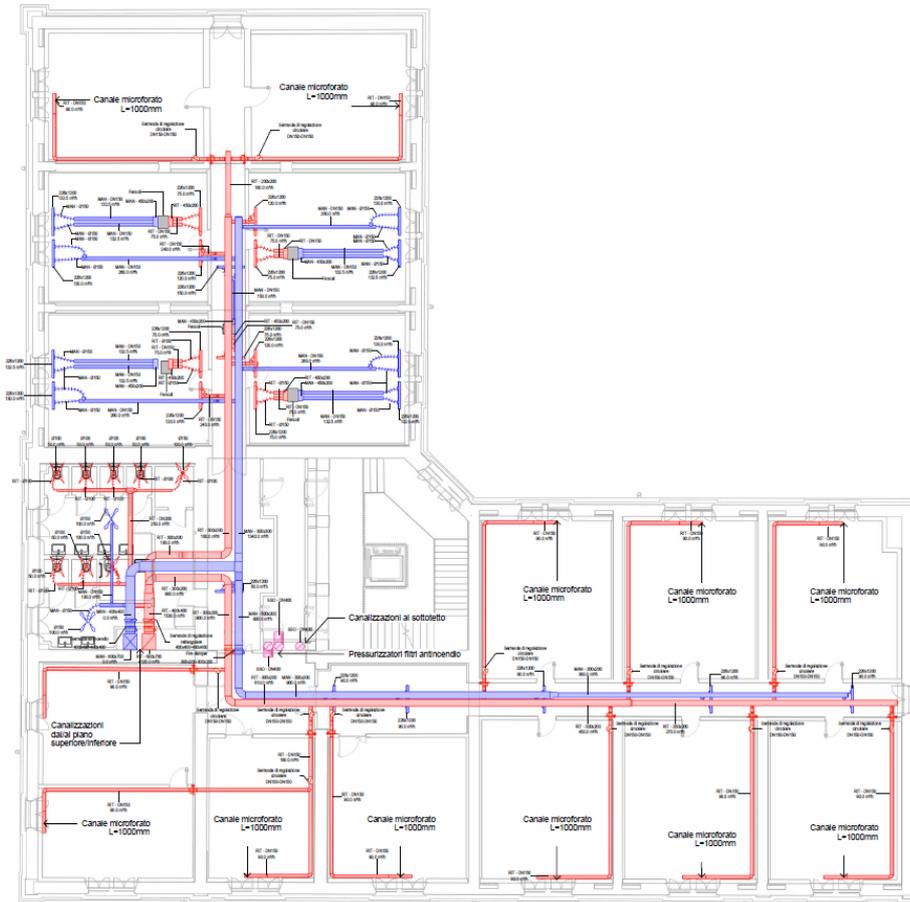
Estratto planimetria primo piano del sistema di ventilazione
